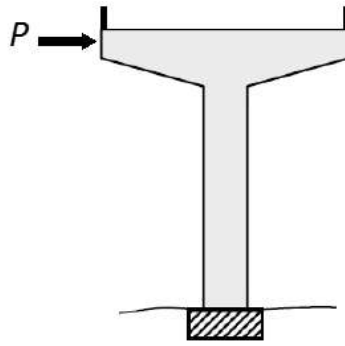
Sistema estructural de puentes tipo viaducto.
